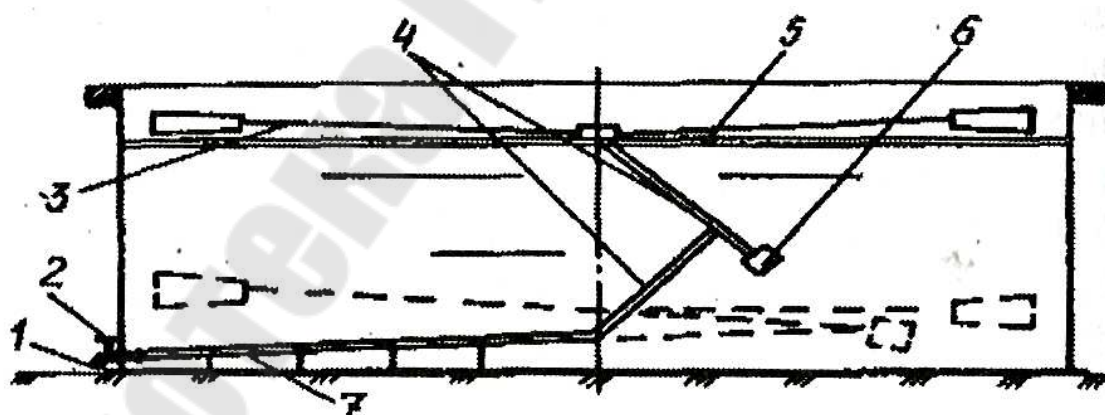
Дренажная система плавающей крыши: 1 - патрубок; 2 - задвижка; 3 - крыша; 4 - труба; 6 - поплавок; 7 - водоотводящий коллектор
